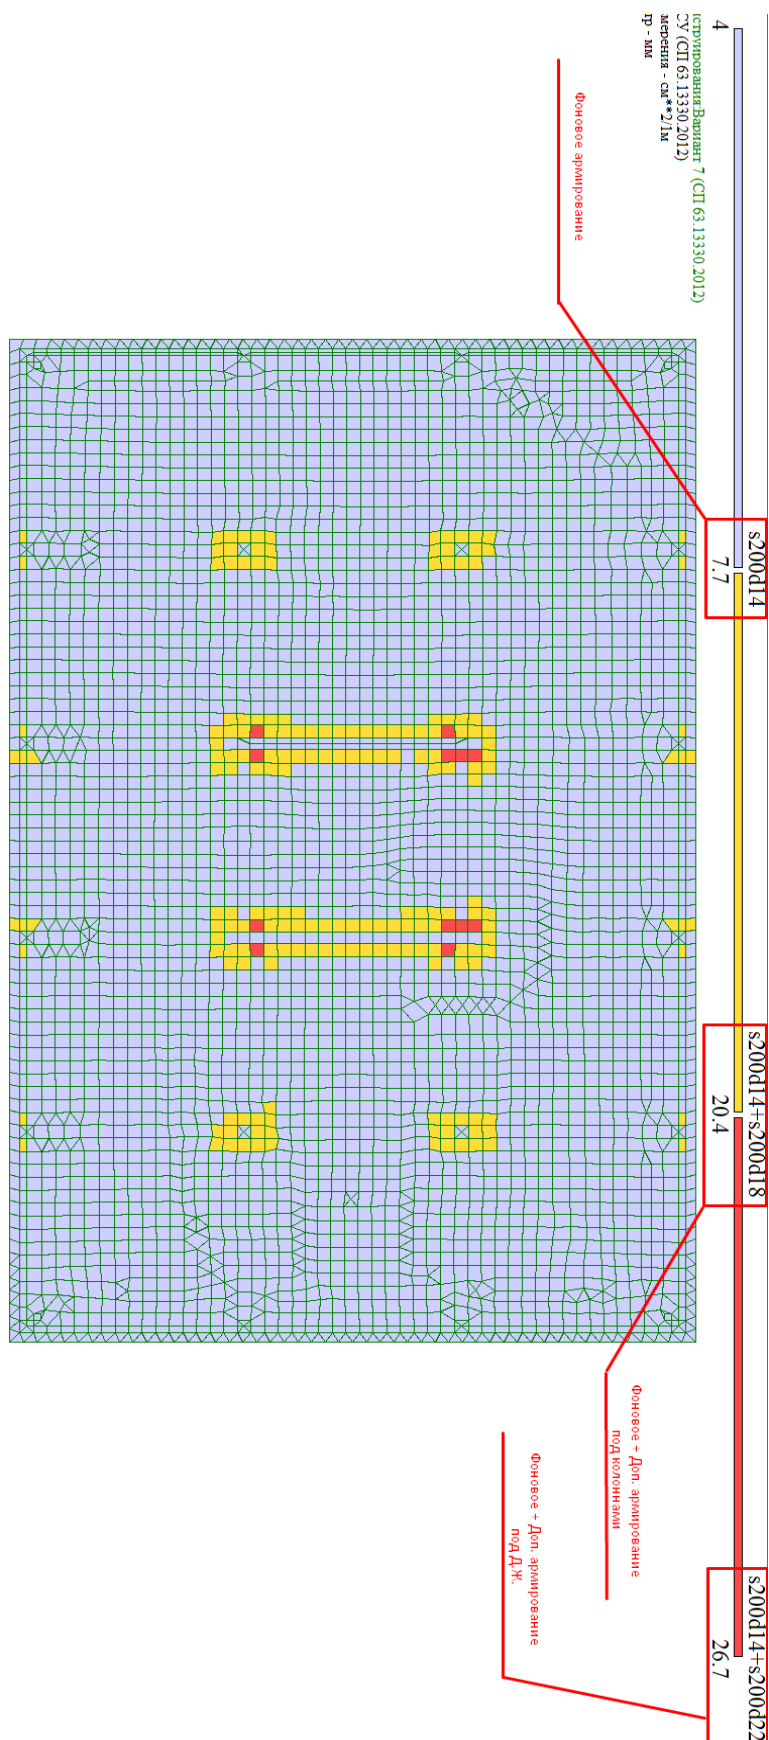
Назначенное нижнее армирование фундаментной плиты
